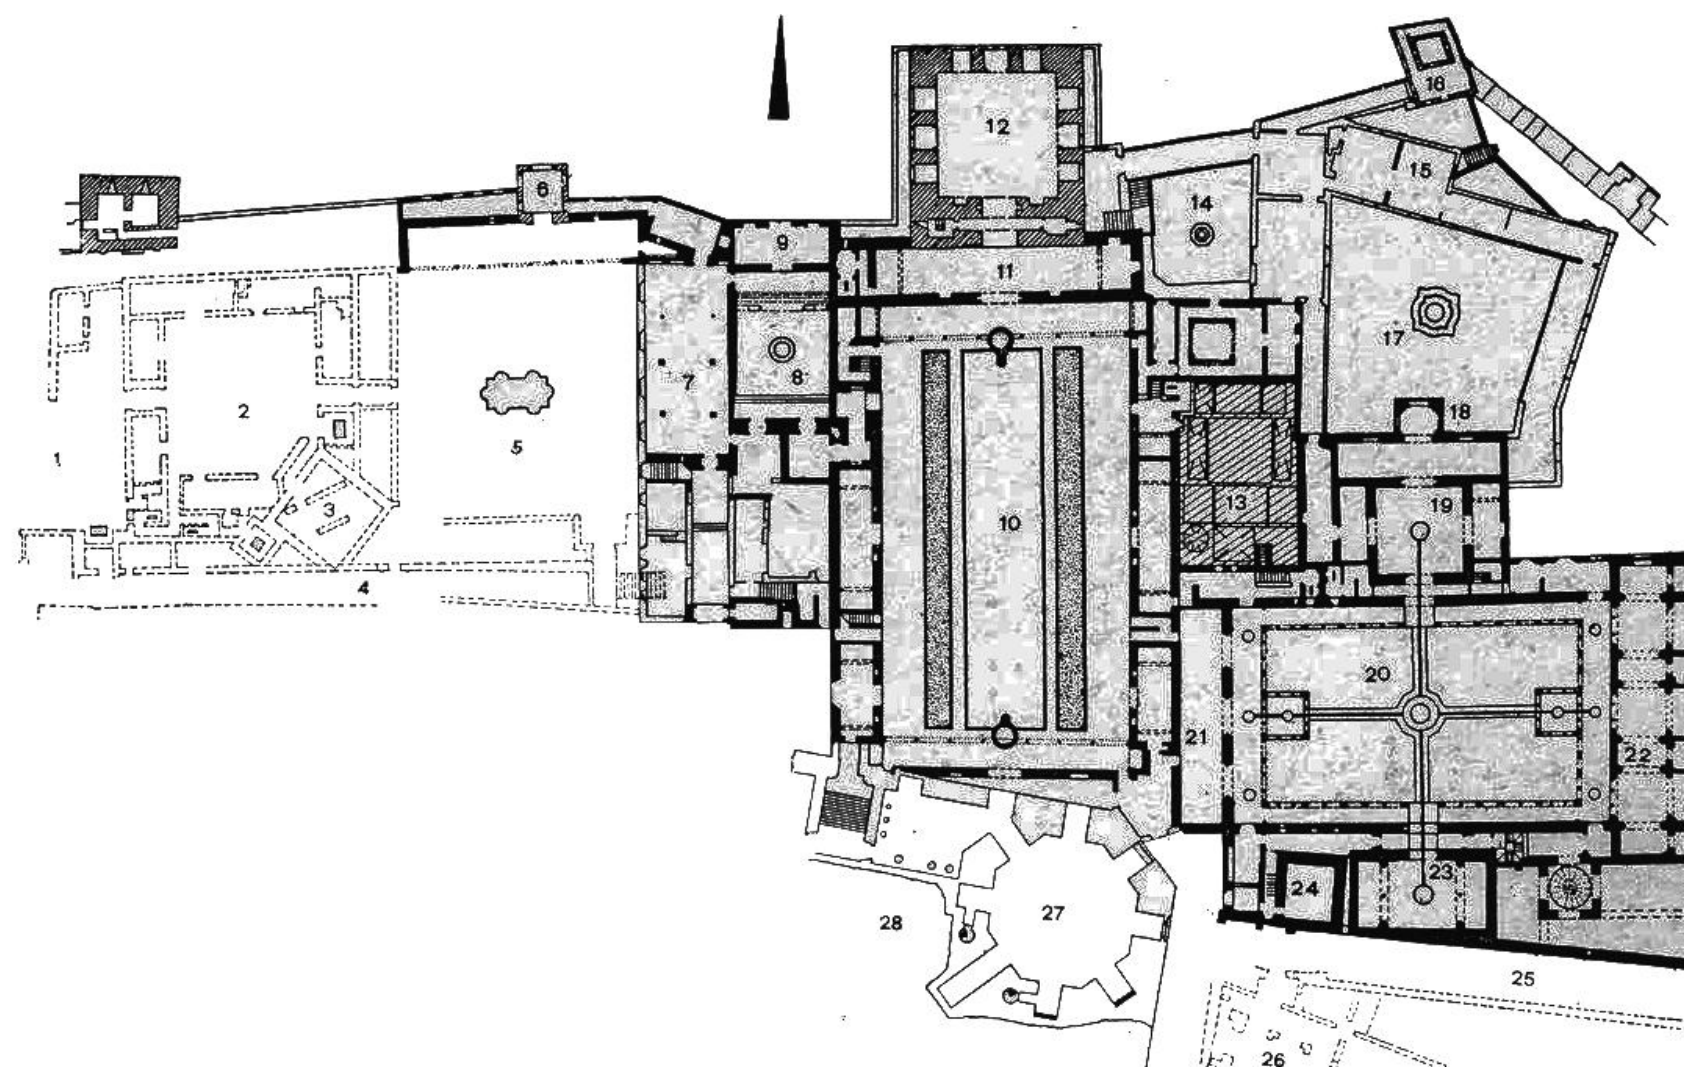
Planta de la Alhambra. (Imagen retocada, extraída de: http://leccionesdesignprofdiezdelcorral.blogspot.com.es/2013_04_01_archive.html)
